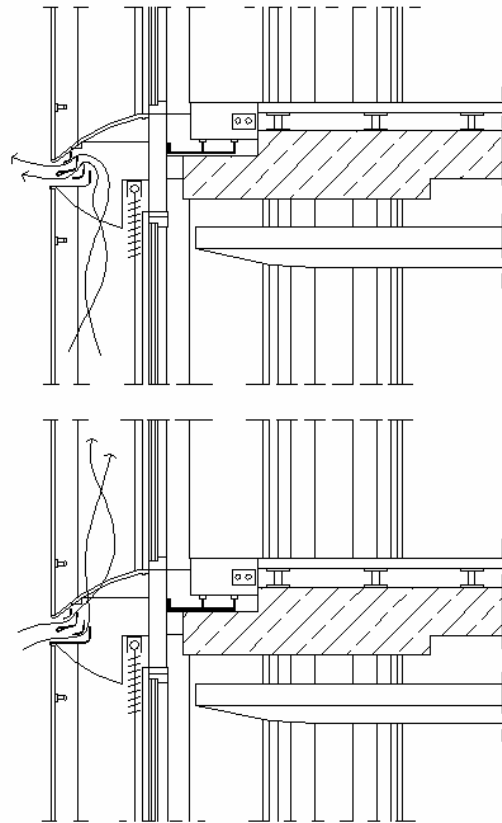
Fassadendetail und –außenansicht von Objekt 1
